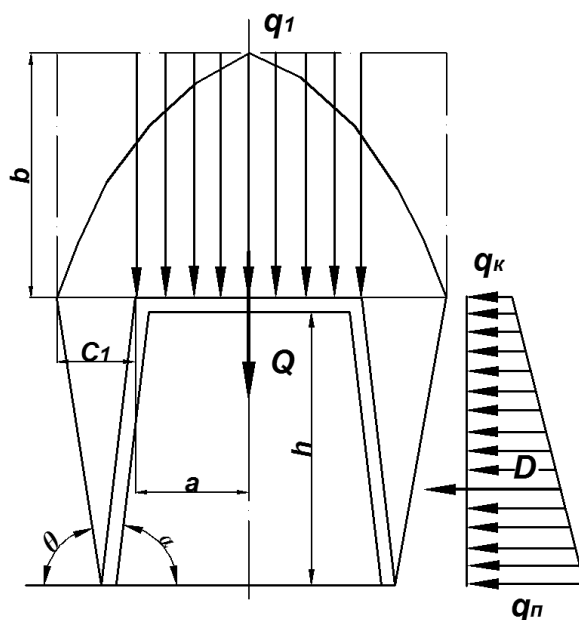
Схемы к расчету нагрузки на крепь при неустойчивой кровле и боках трапециевидной форме выработки
